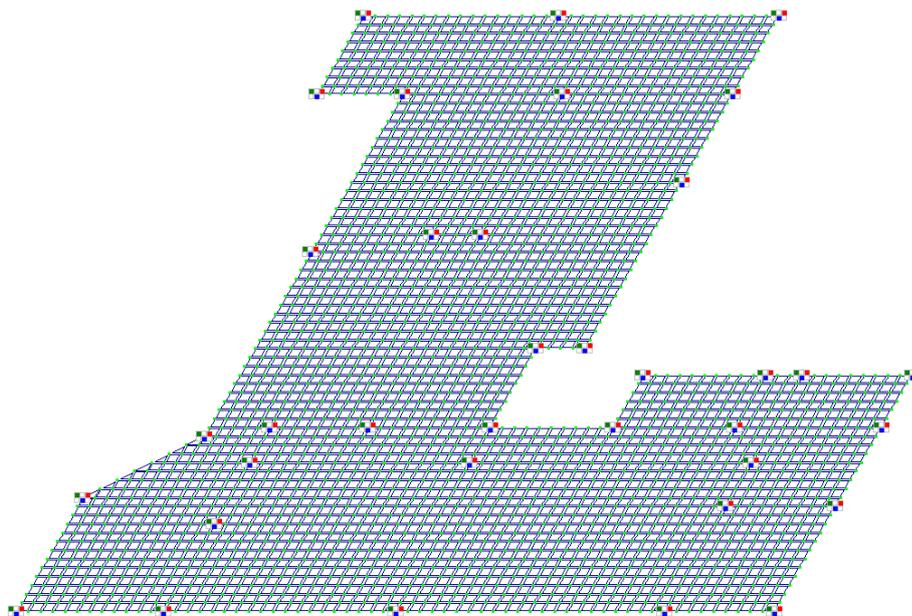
«Расчетная схема монолитного железобетонного перекрытия
